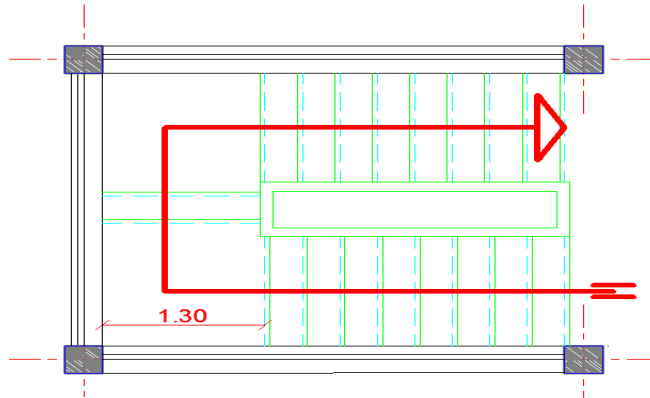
Vue en plan d'escalier à trois volées (1^{er} étage).
